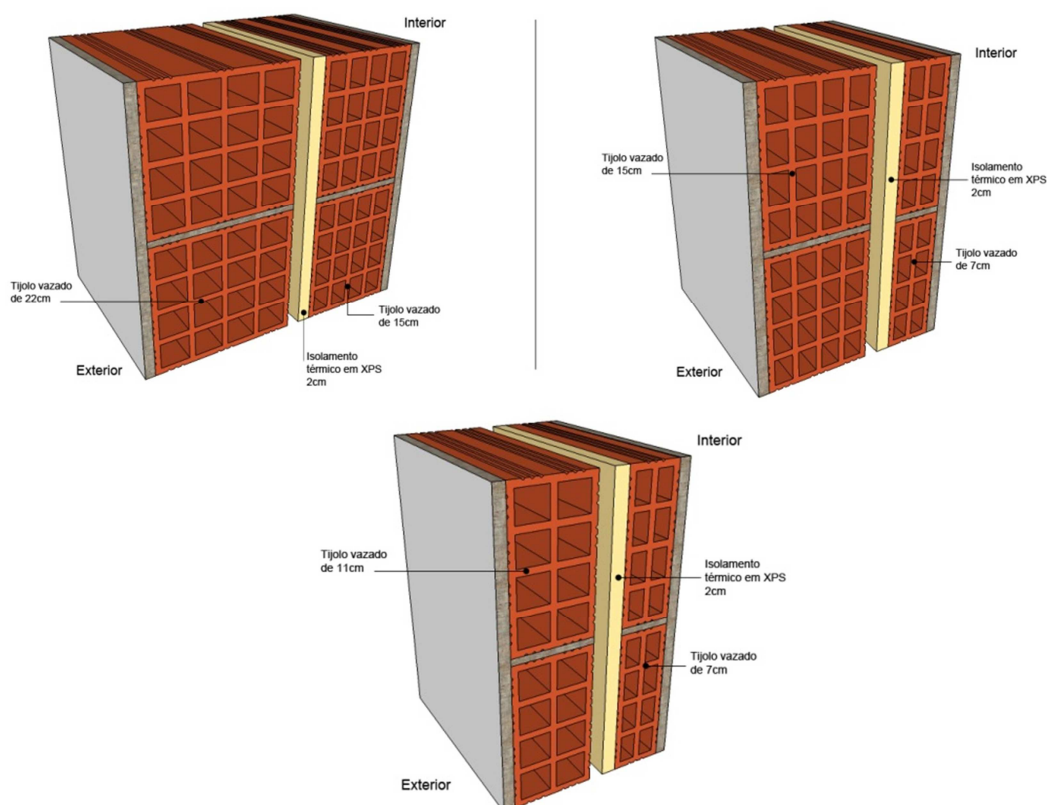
Soluções construtivas em alvenaria de tijolo vazado
